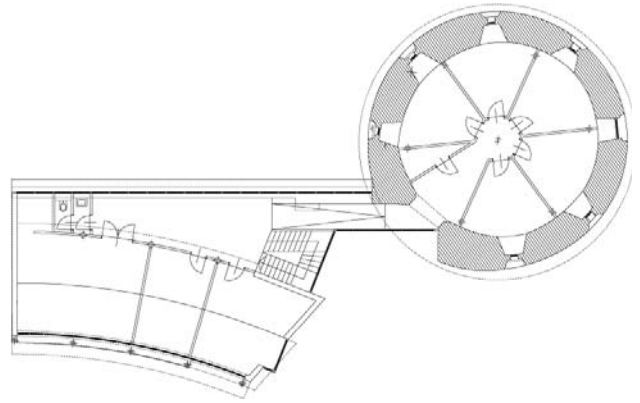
Radstadt Teichturm, Grundriss
